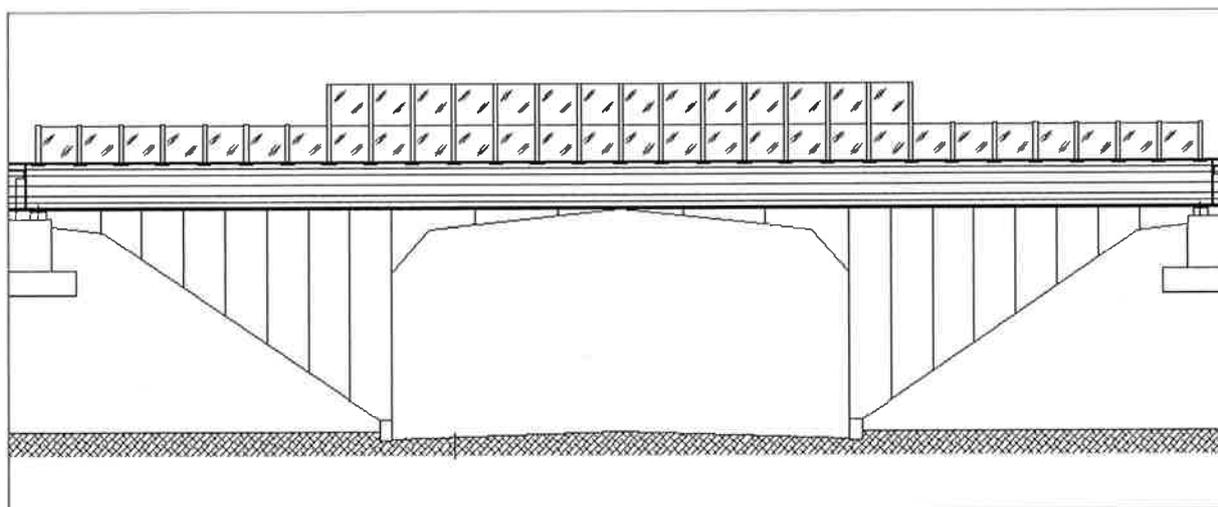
Prospetto marciapiedi ai lati del cavalcavia stradale esistente
